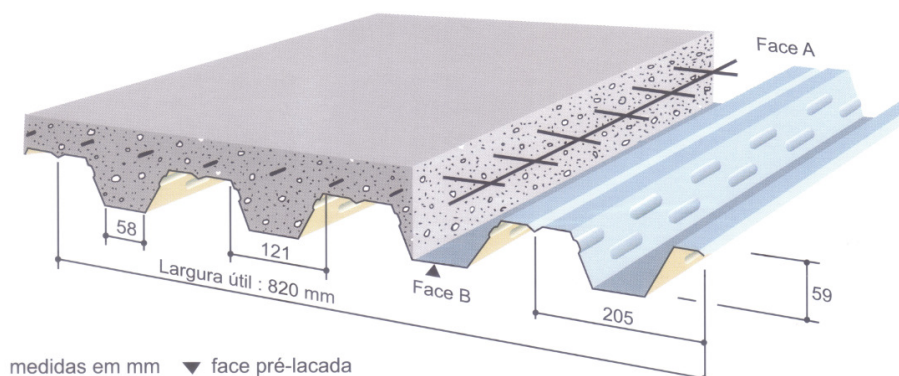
Dimensões do perfil adotado para a laje mista (ArcelorMittal (2013))
